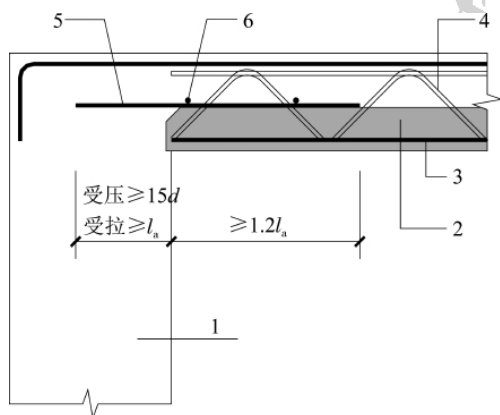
桁架钢筋混凝土叠合板端支座构造示意
